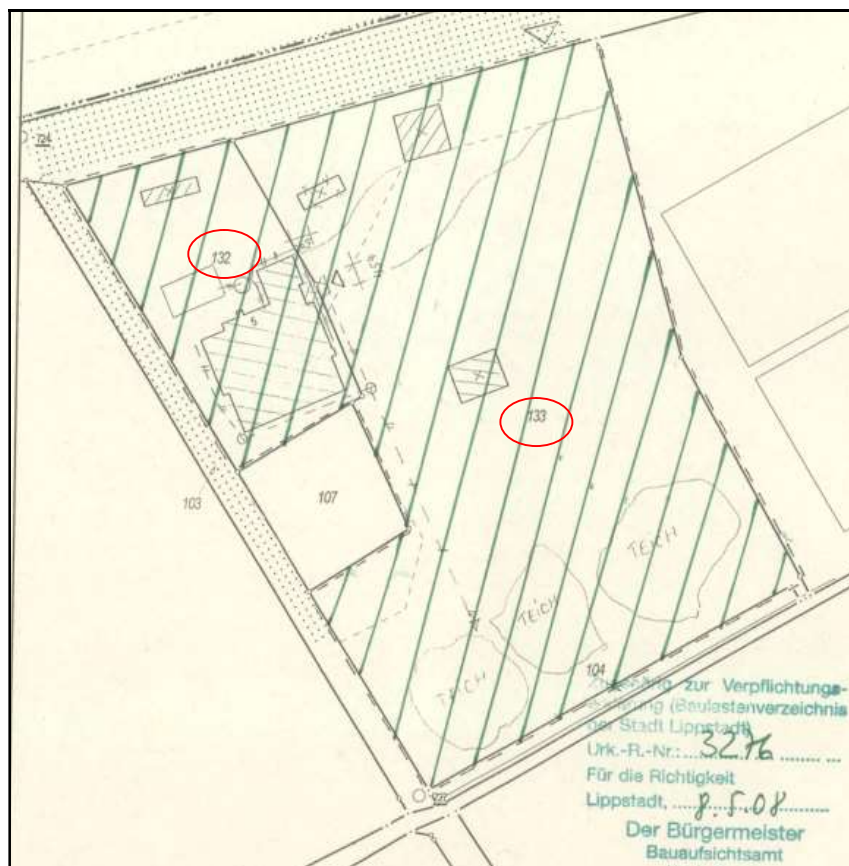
Lageübersicht zur Baulast der Flurstücke 132 und 133 (ohne Maßstab)
